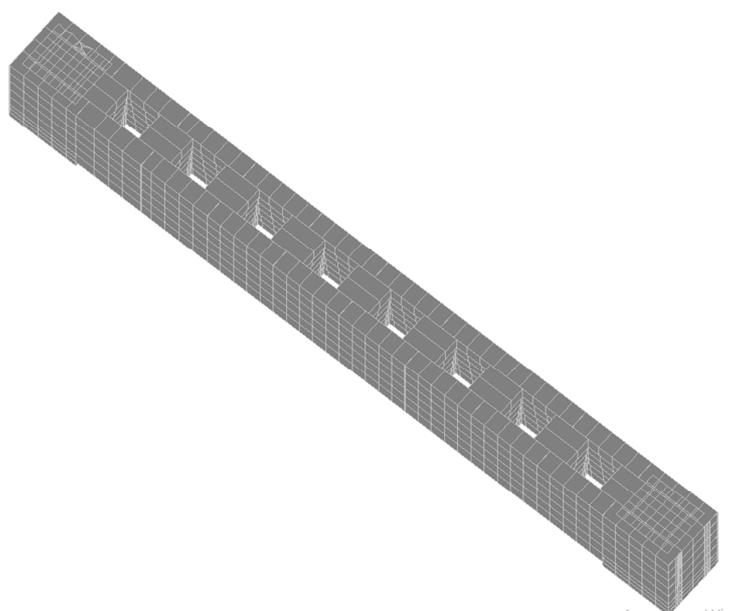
Продольные ребра железобетонной балки ростверка с разными жесткостями
